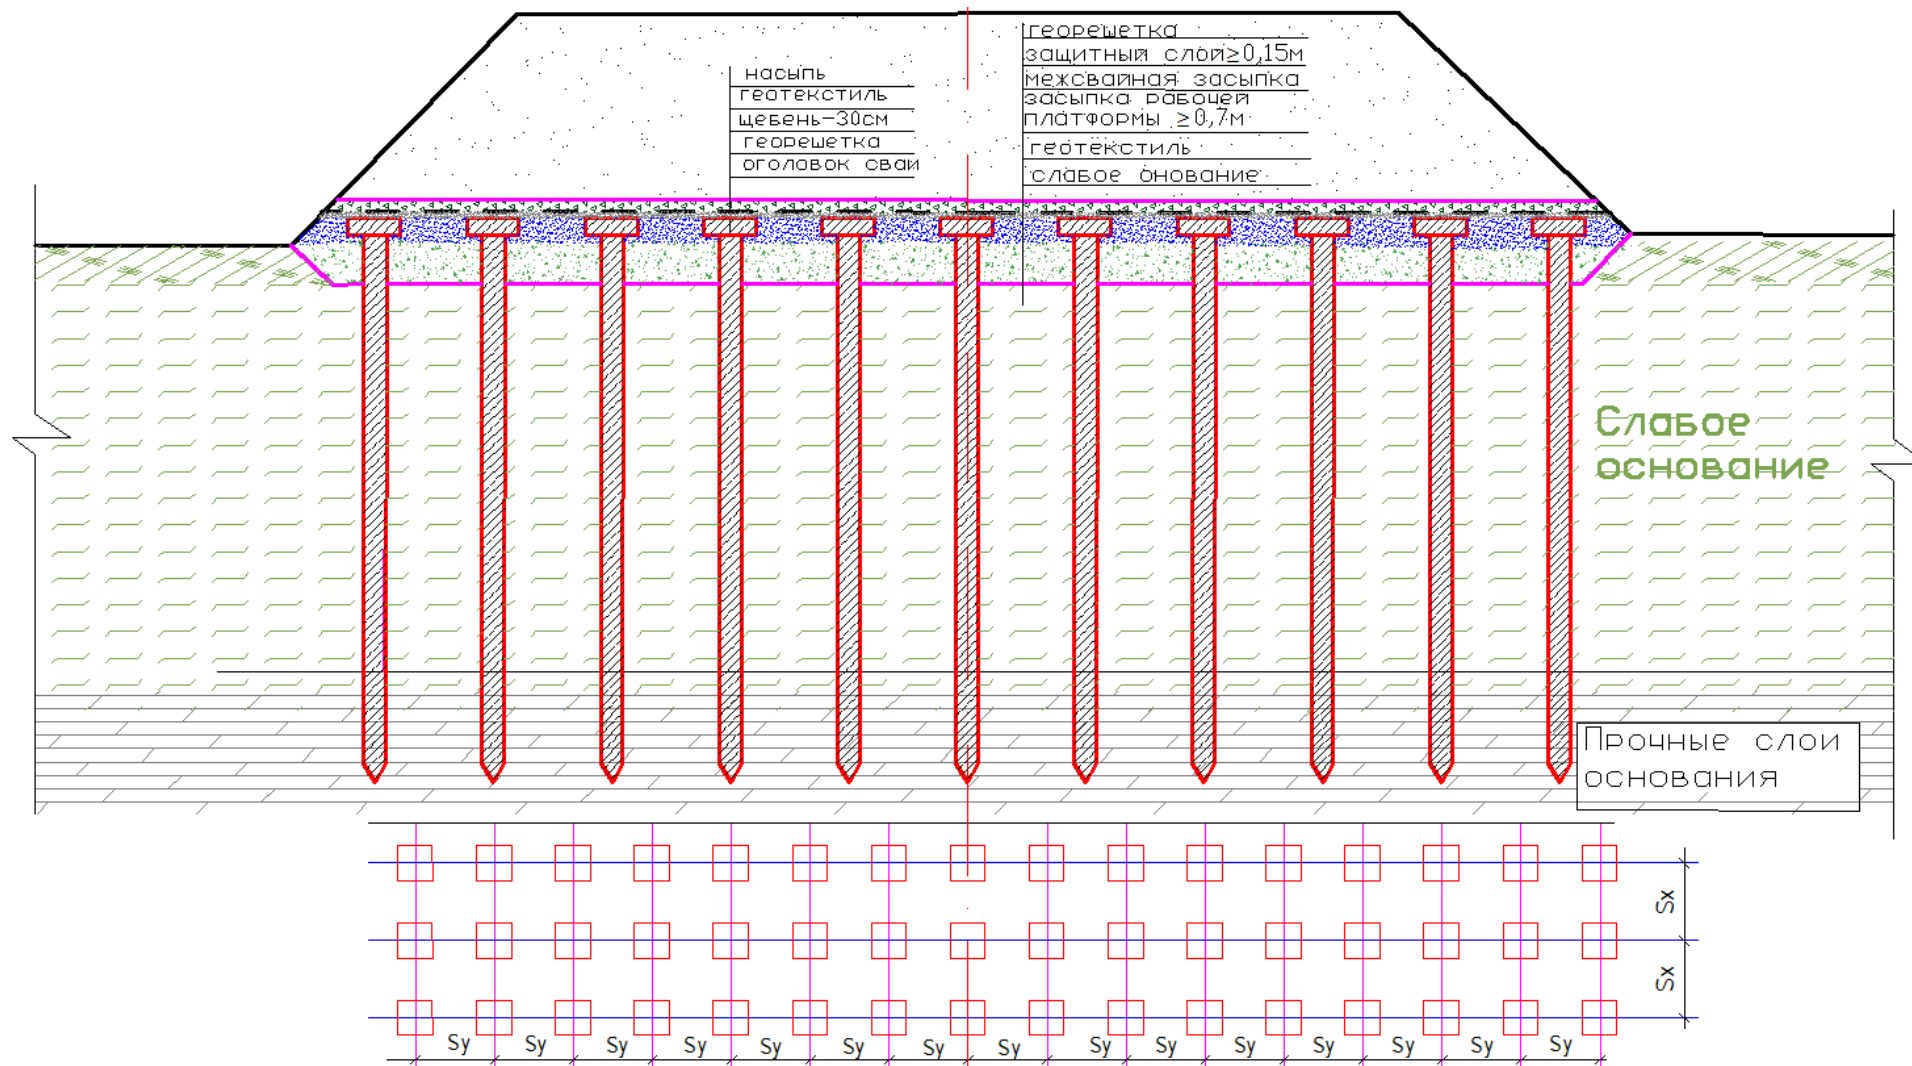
Гибкий ростверк из одного слоя георешетки со щебнем на железобетонных сваях с оголовками (с размещением свай по квадратной сетке)
